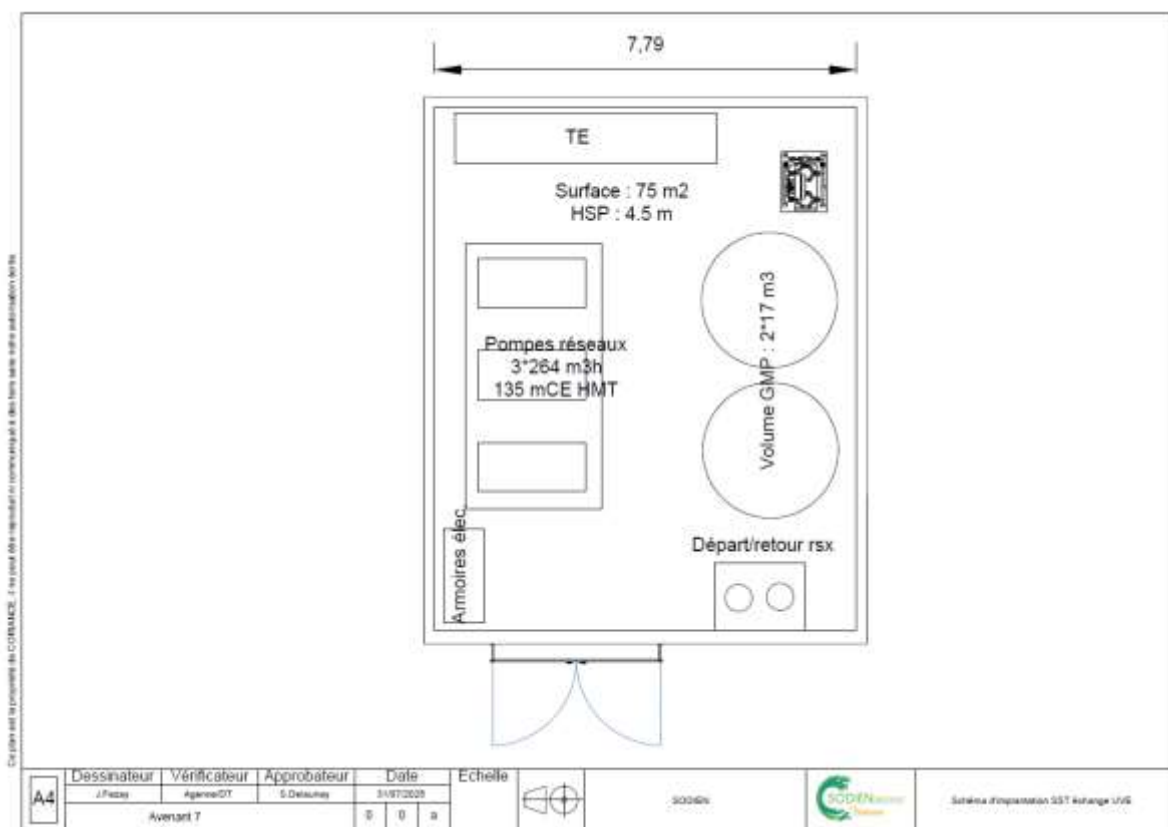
Schéma d'implantation de la sous-station d'échange installée sur le site de l'UVE
